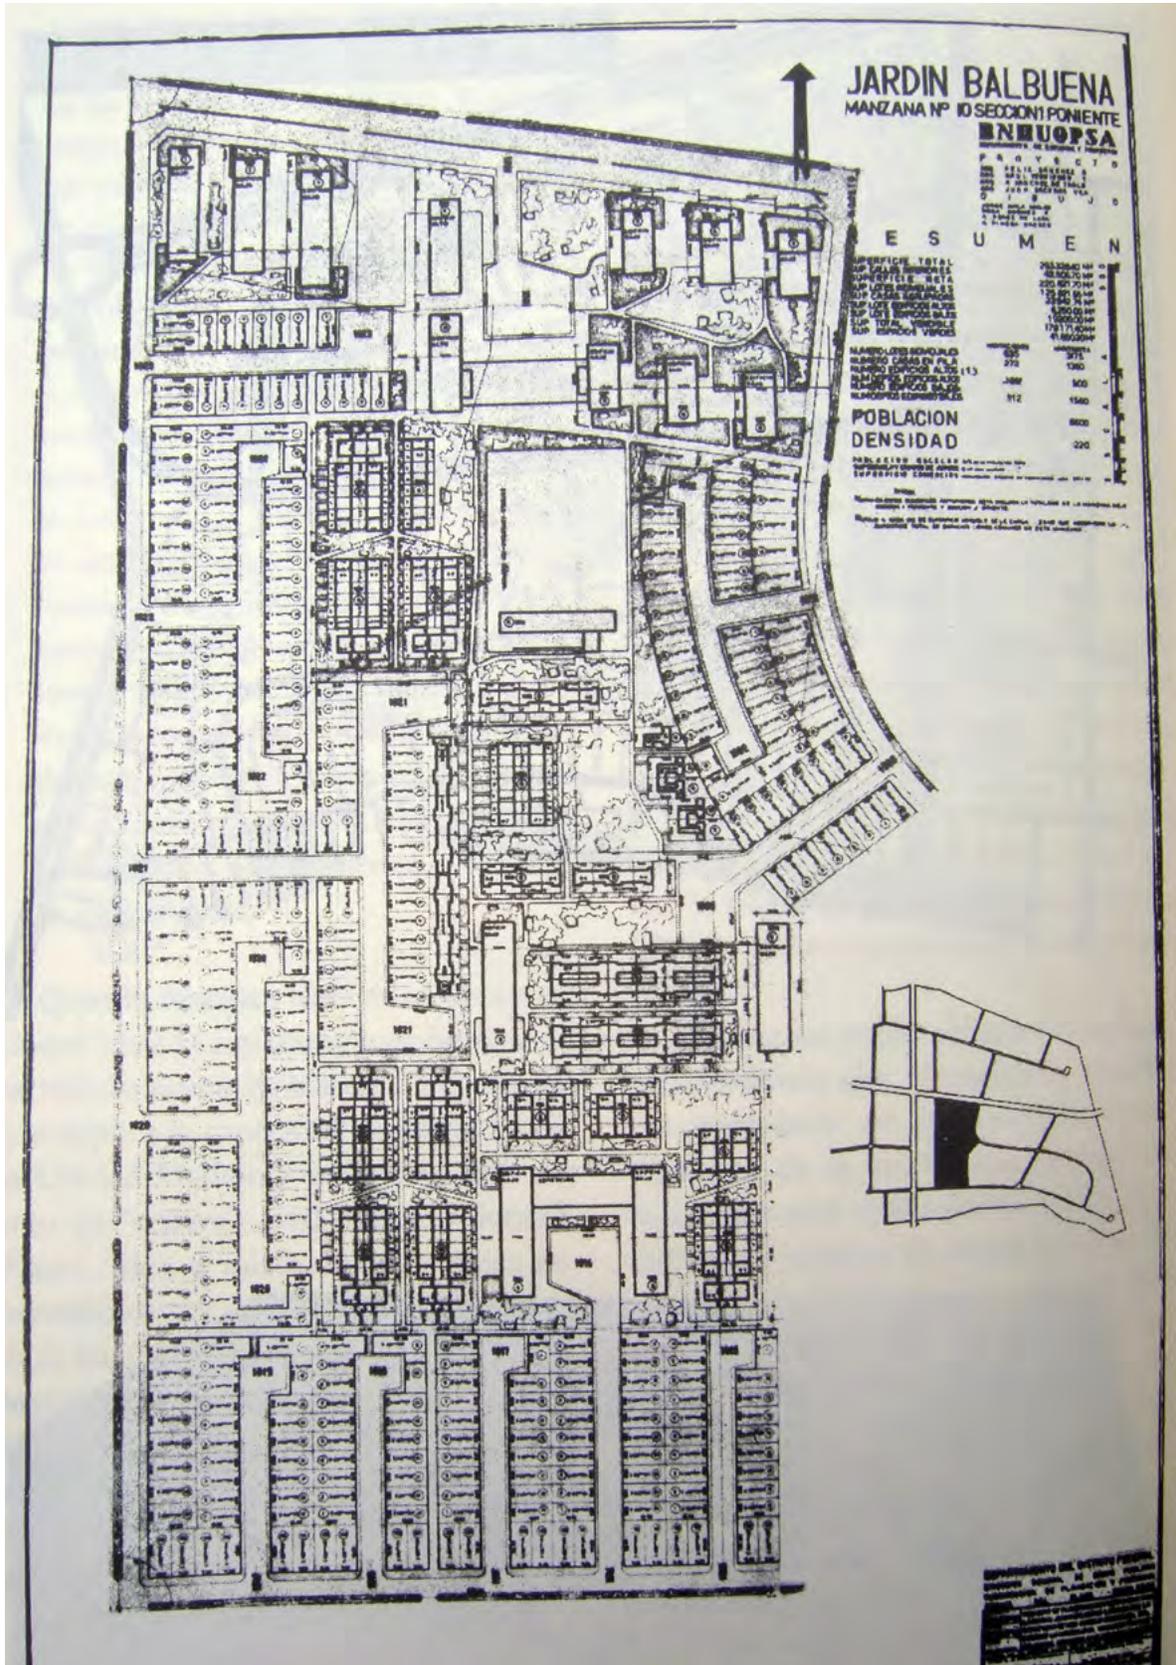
Planta de conjunto del proyecto Jardín Balbuena. Fuente: Enrique X. de Anda A., op. cit., p. 238.
